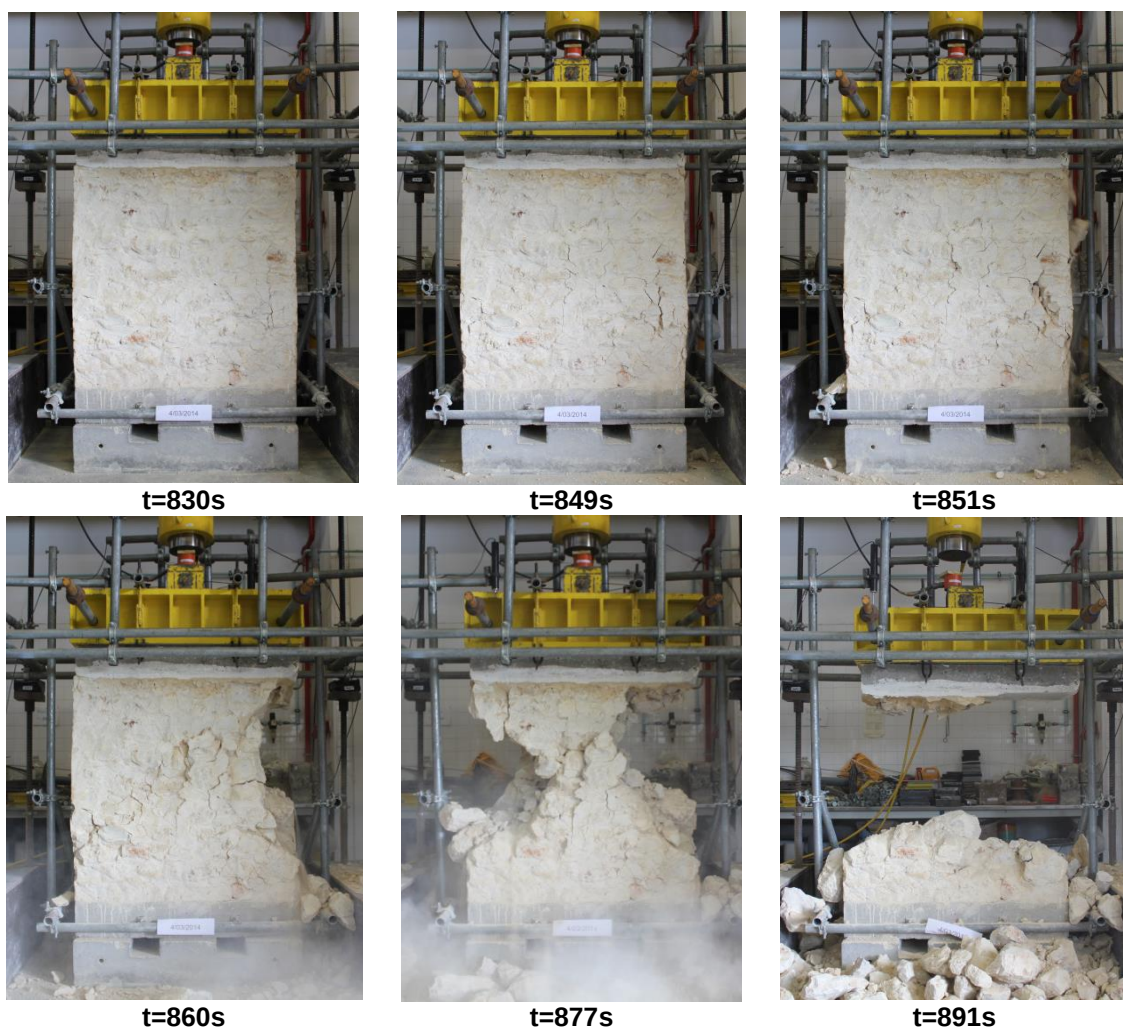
Ensaio de compressão axial sobre o murete m11.
